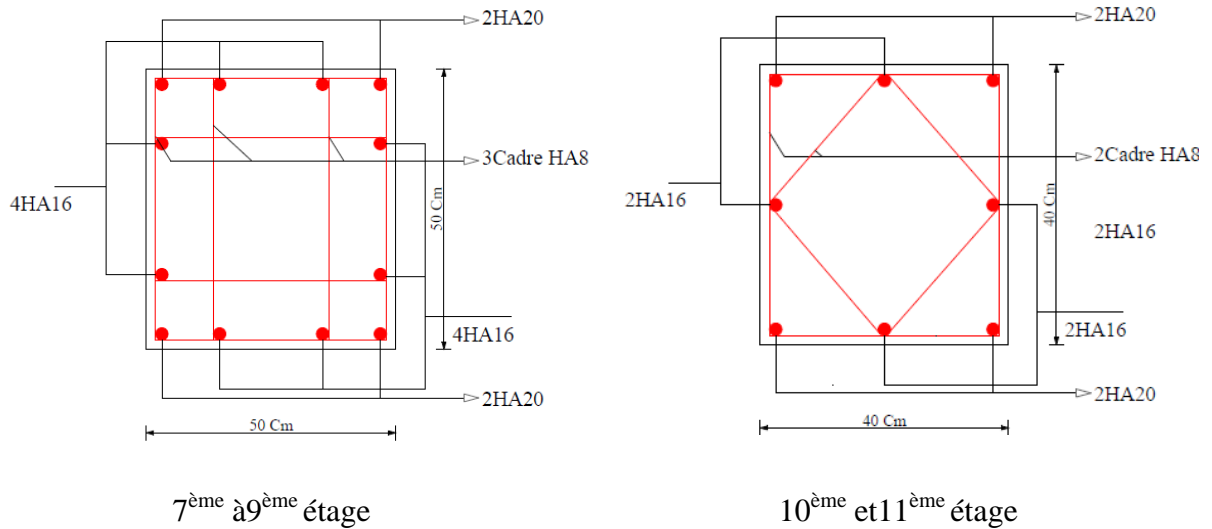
Schéma de ferrailage des poteaux rectangulaires.
